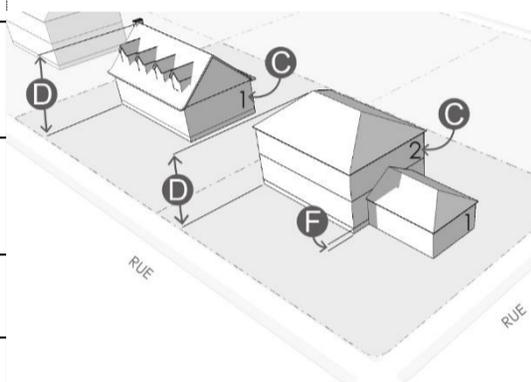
Hauteur d'un bâtiment et du plancher du rez-de-chaussée
